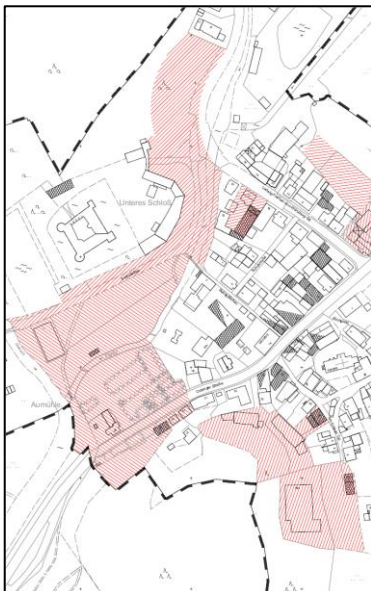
Städtebauliche Missstände, Lauer+Lebok Architekten
